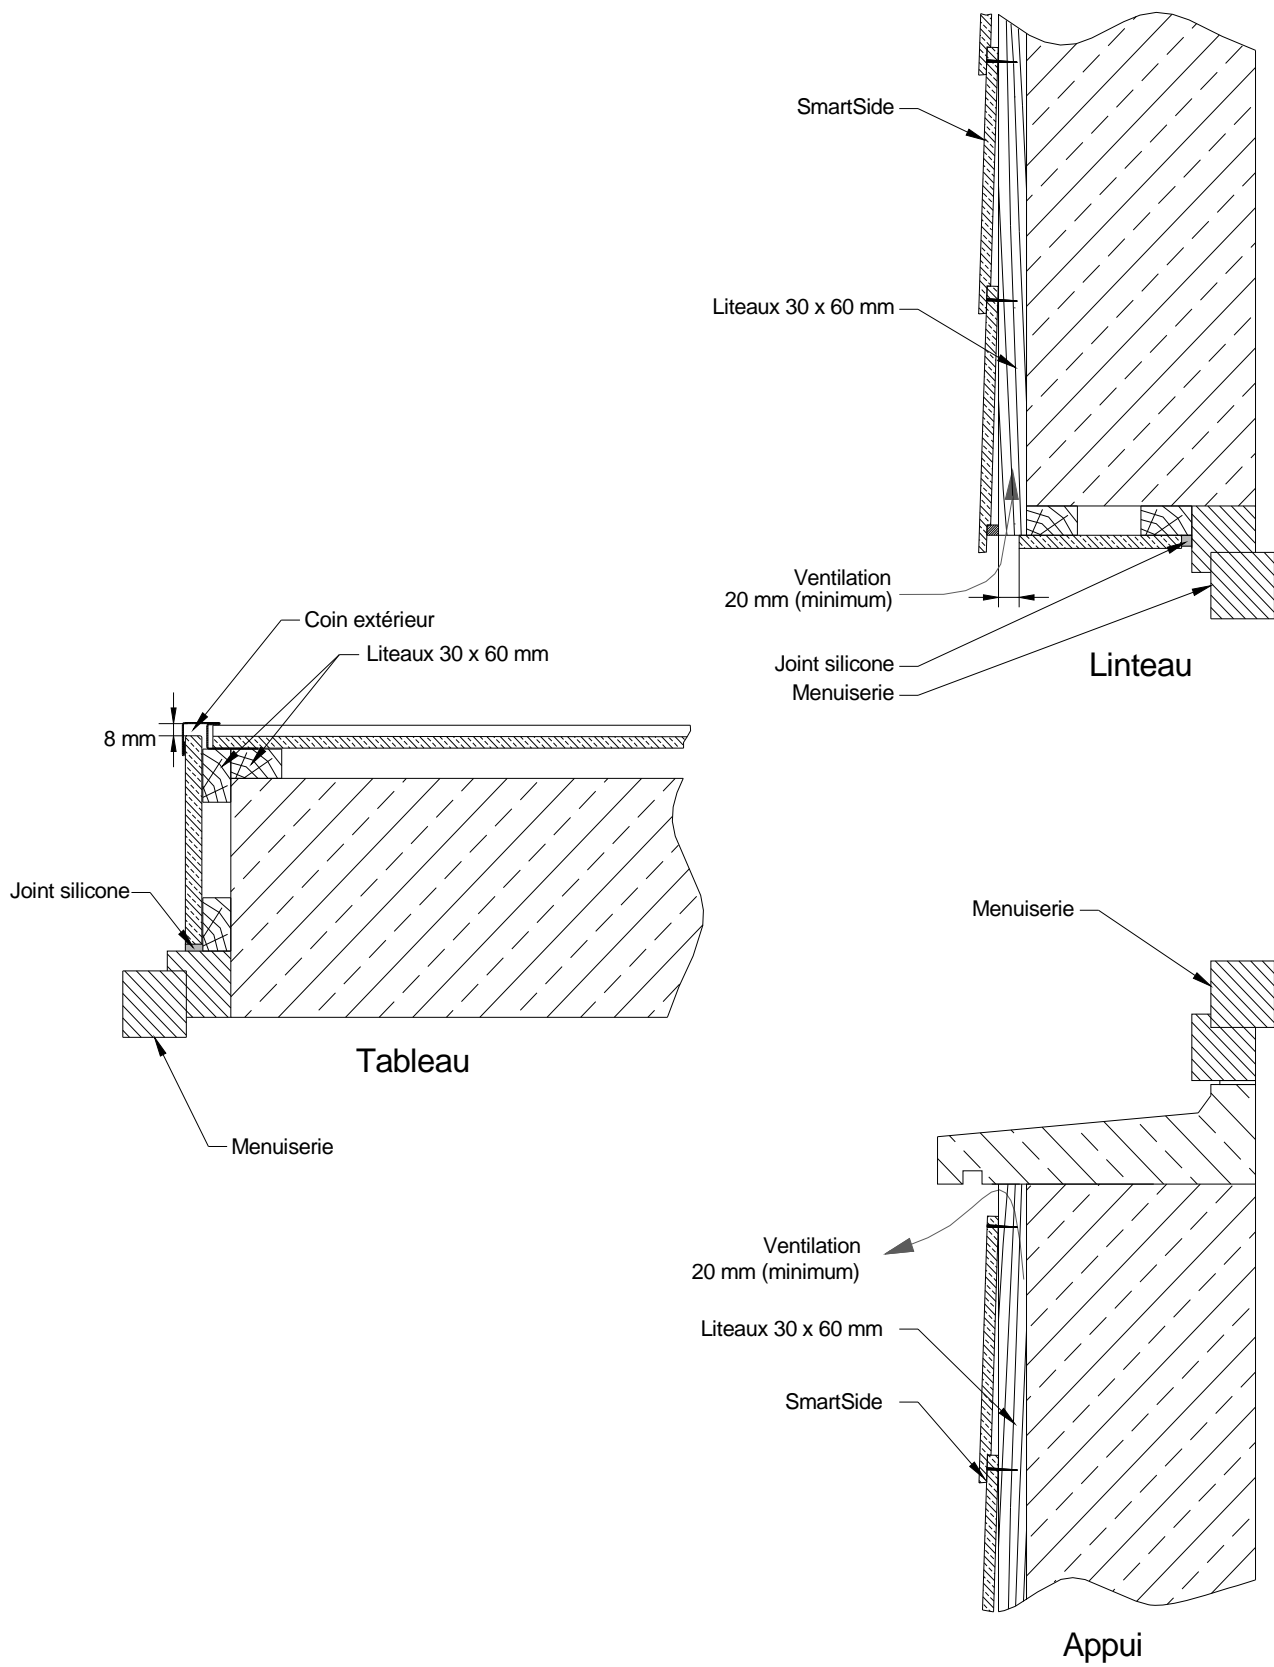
Coupe sur menuiserie avec tableaux maçonnerie
